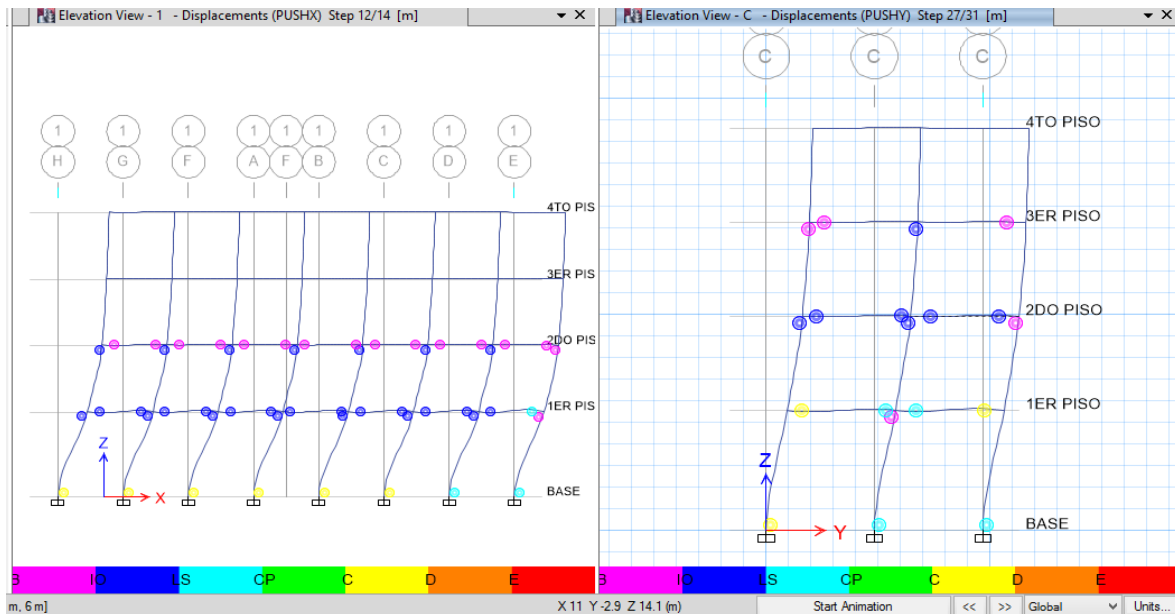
Desplazamientos máximos 24 columnas de 4 niveles
